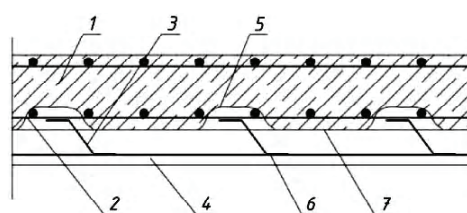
Нарастивание монолитного слоя снизу: 1 – усиваемая плита; 2 – рабочая арматура усиления; 3 – арматурные отгибы; 4 – торкретбетон; 5 – вырубленный защитный слой бетона; 6 – сварка; 7 – нижняя поверхность плиты, подготовленная к бетонированию.
